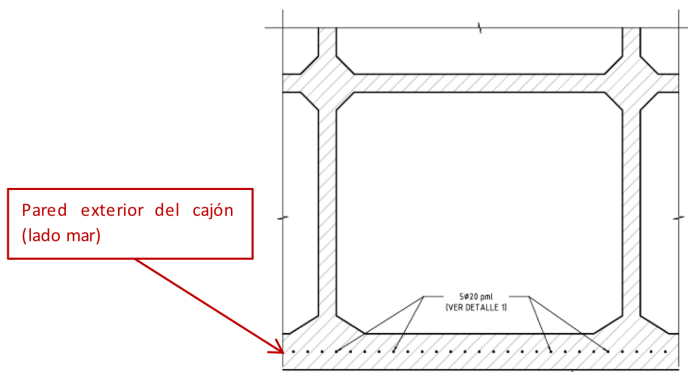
Espaldón de hormigón armado. Detalle de armadura vertical pasante de conexión del espaldón con la pared exterior del cajón
